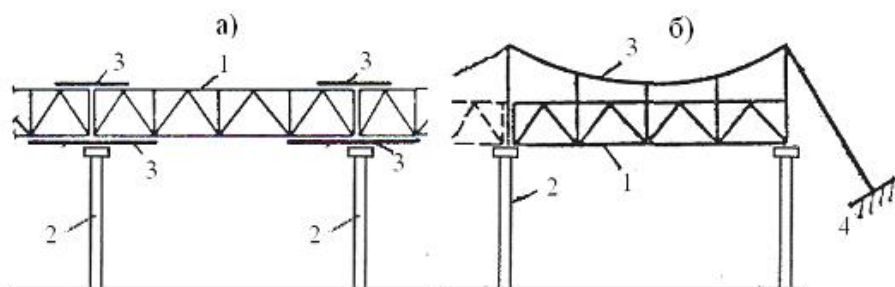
Усиление стропильных ферм путем превращения их в неразрезные многопролетные конструкции или надстройки висячих (вантовых) систем:
